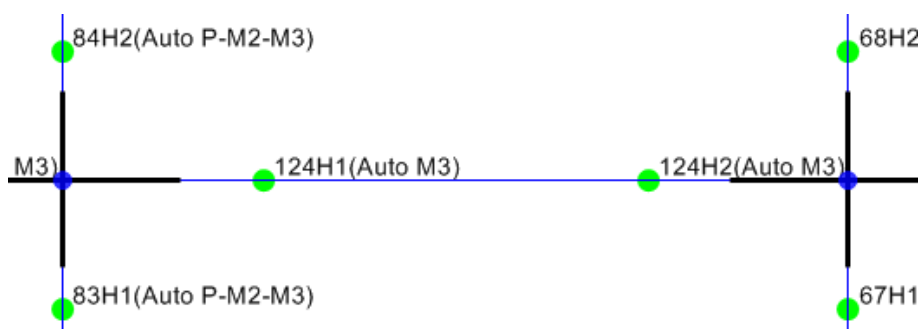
Rótulas plásticas asignadas en las vigas.
